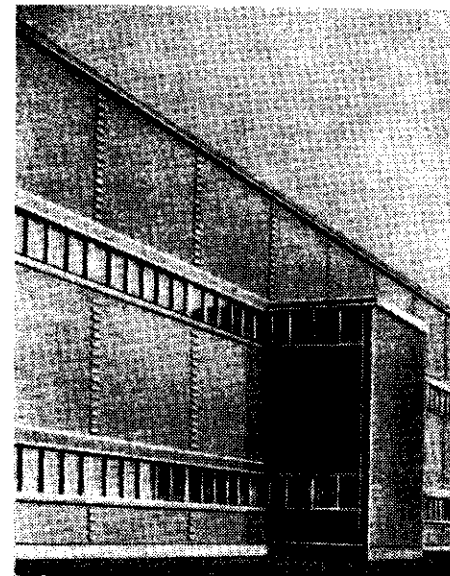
Художественно обработанная кладка стен сборочного корпуса
